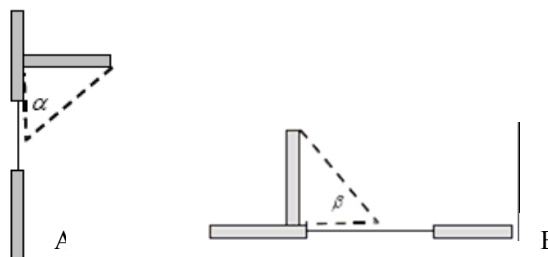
Aggetti orizzontali e verticali (A: sezione verticale; B: sezione orizzontale)
